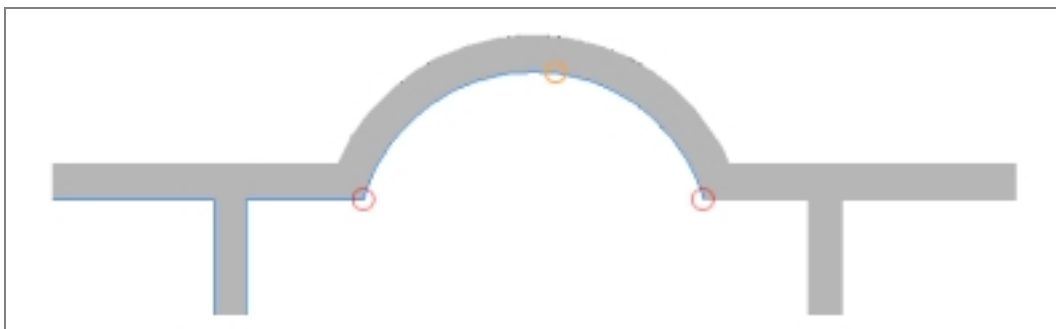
Bauaufnahmемодуль – gekrümmtes Wandbauteil zwischen zwei Raumeckpunkten definiert über einen Bogenpunkt
